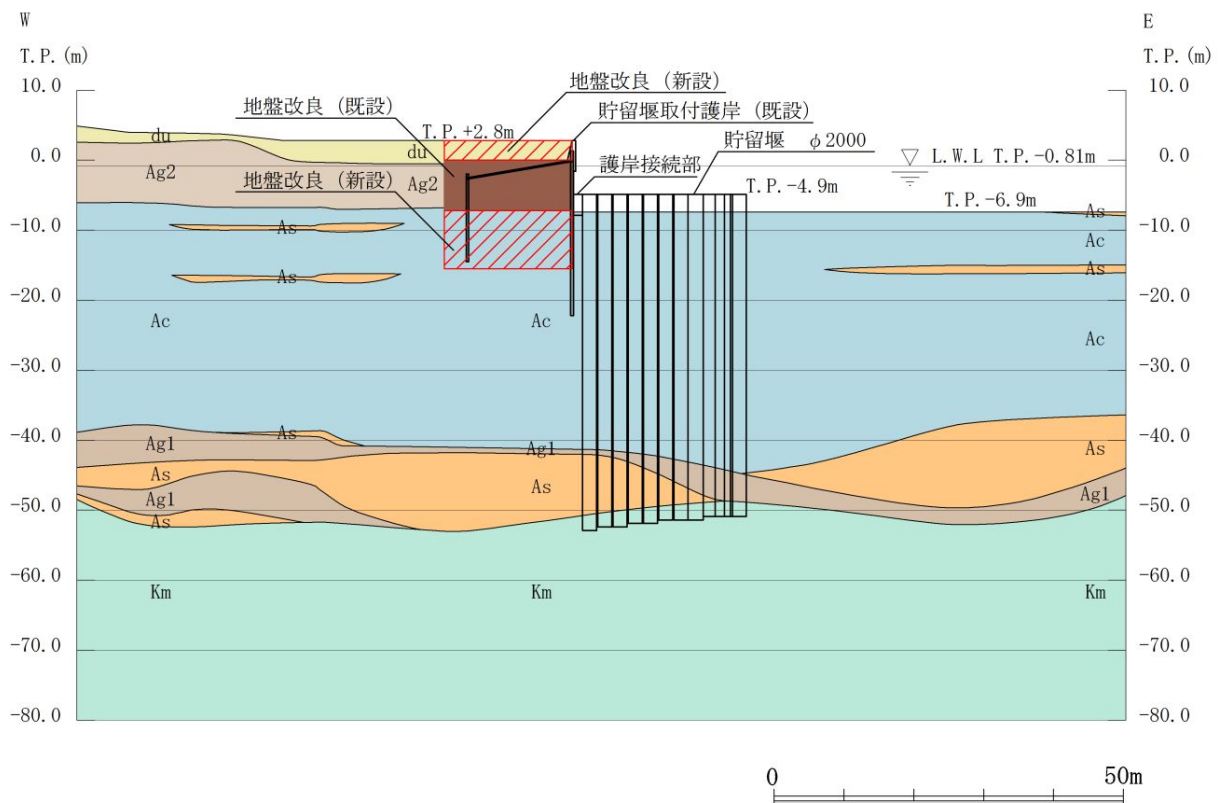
貯留堰取付護岸の断面図 (EW-1)
